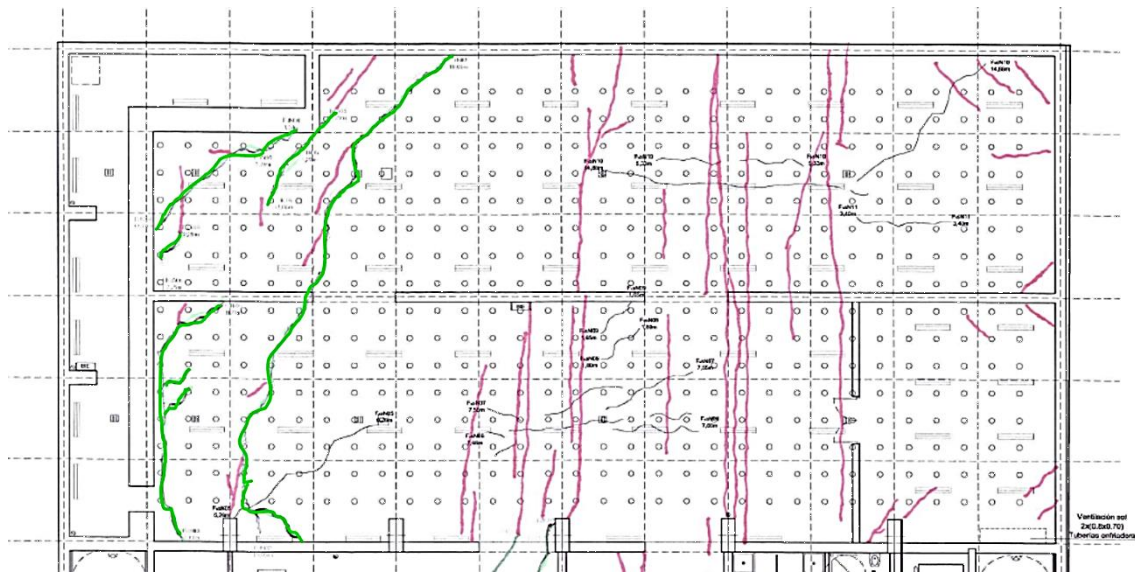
Levantamiento de las fisuras en la cara inferior de la losa de 90 cm a fecha de 10/02/2016.
